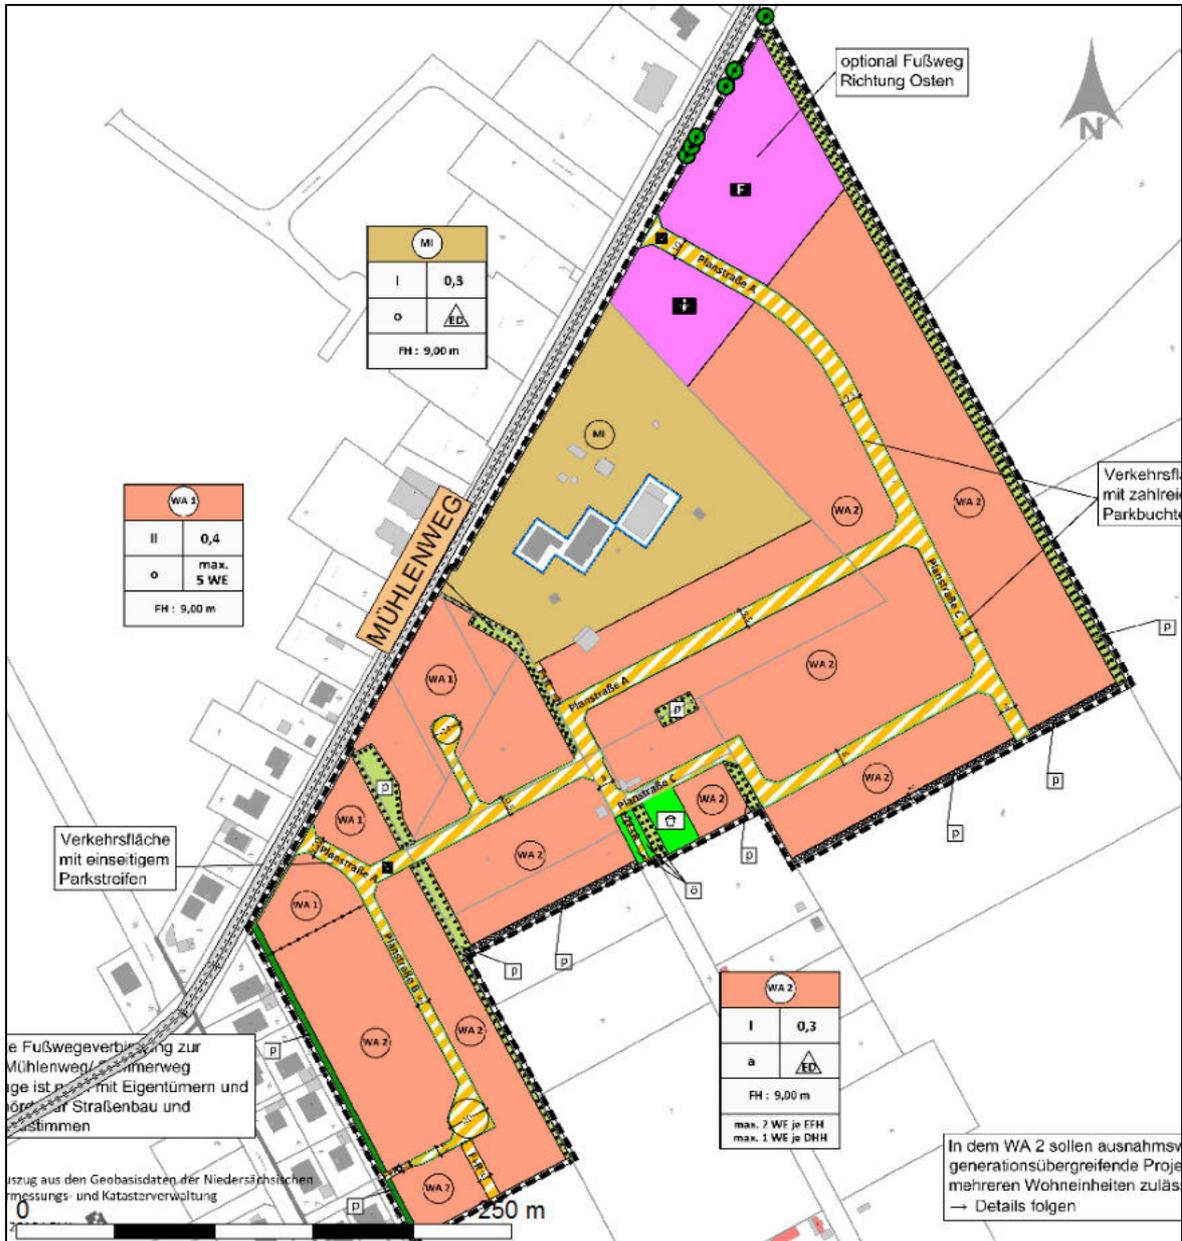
Lageplan mit den beurteilungsrelevanten Verkehrswegen.
